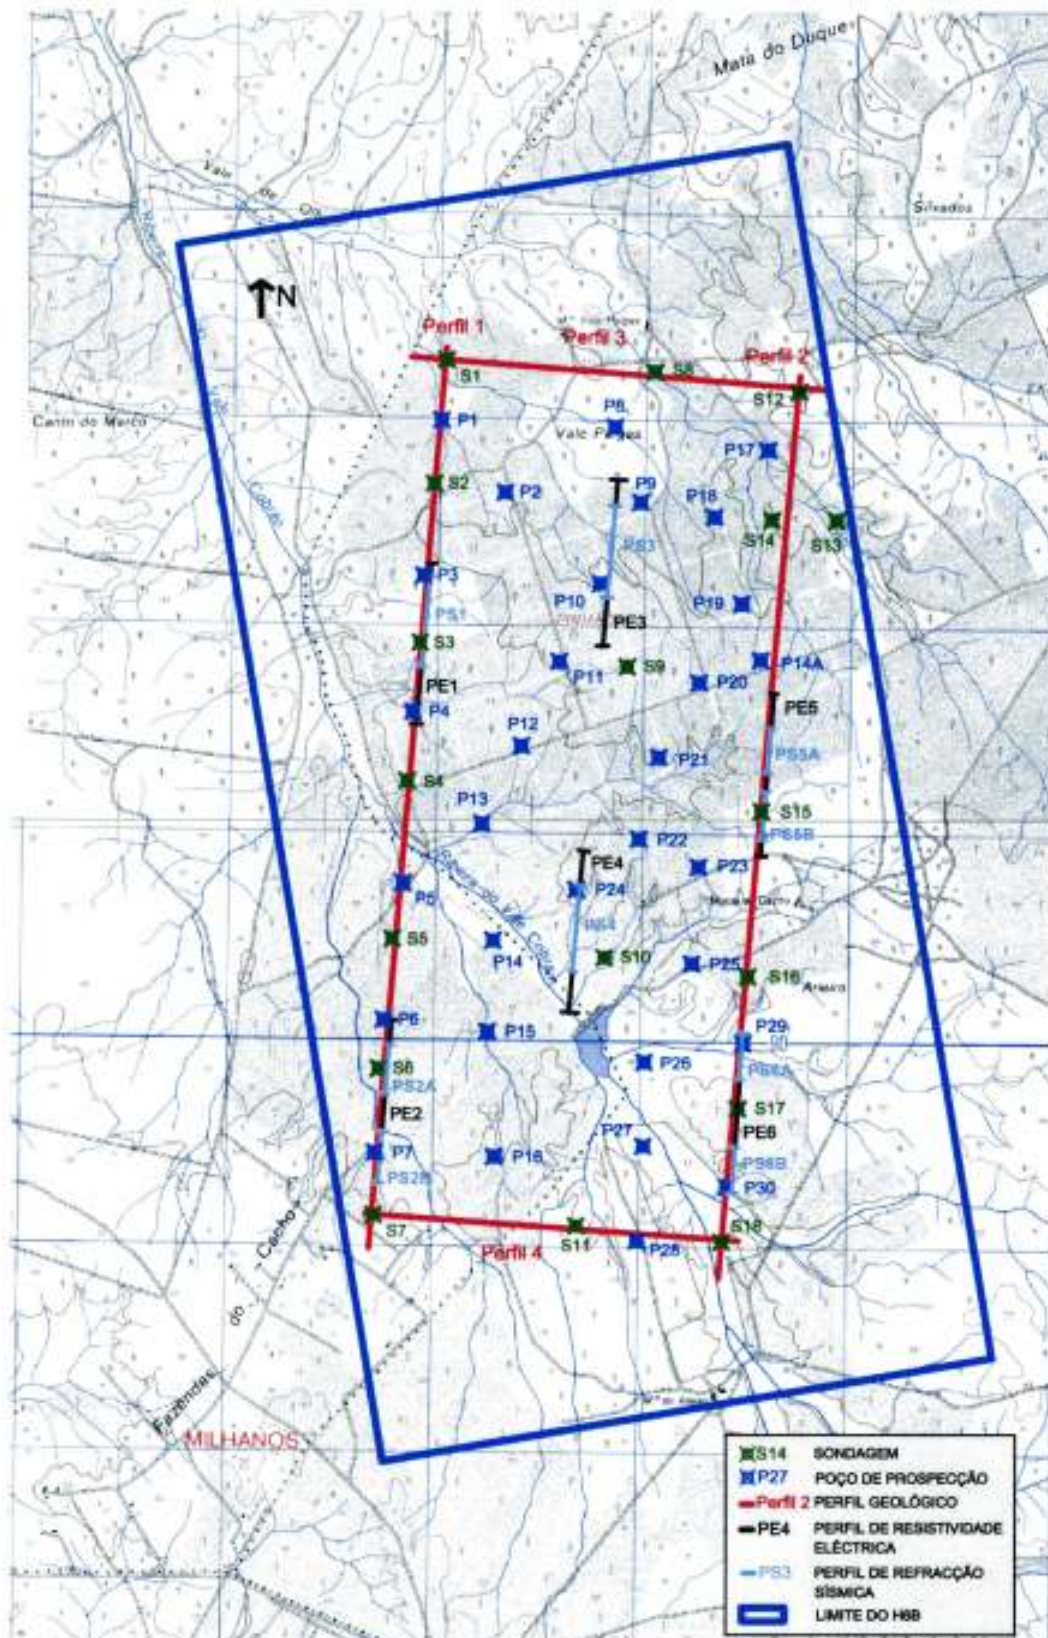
Planta de localização dos trabalhos de prospeção na localização na zona do CTA
